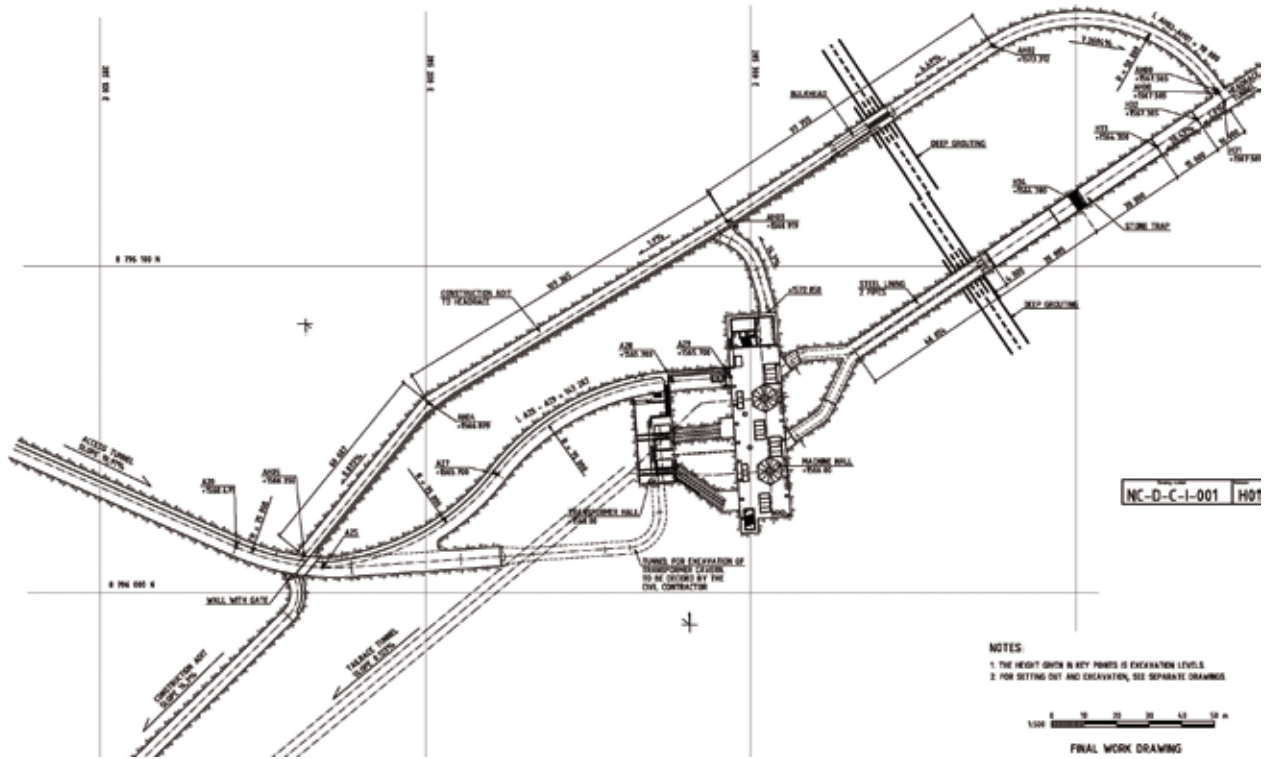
Vista en planta del complejo de Casa de Máquinas
